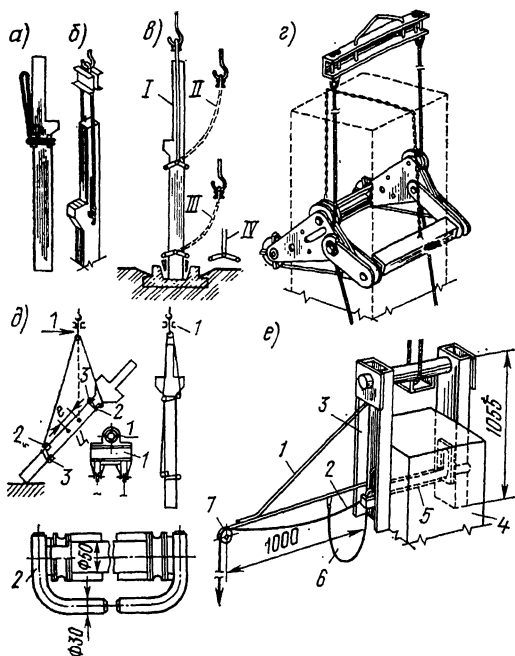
Способы строповки и подъема железобетонных колонн
